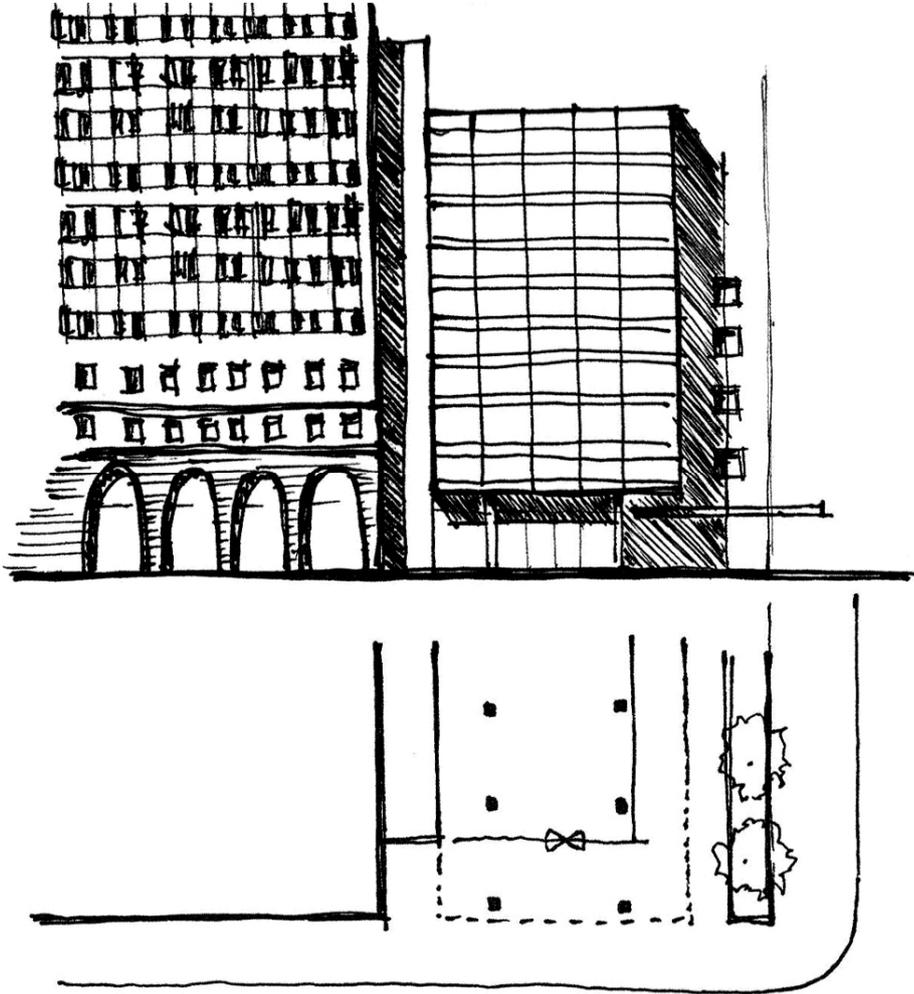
Plano de situación de la parcela. Solar en esquina formado por la calle 59 y Park Avenue. Landmark Site: Manhattan Tax Map Block 1294, Lot 37 (Fuente: Sanborn Manhattan Land Book (1993-94), pls. 84,104) (Modificado por el autor)
